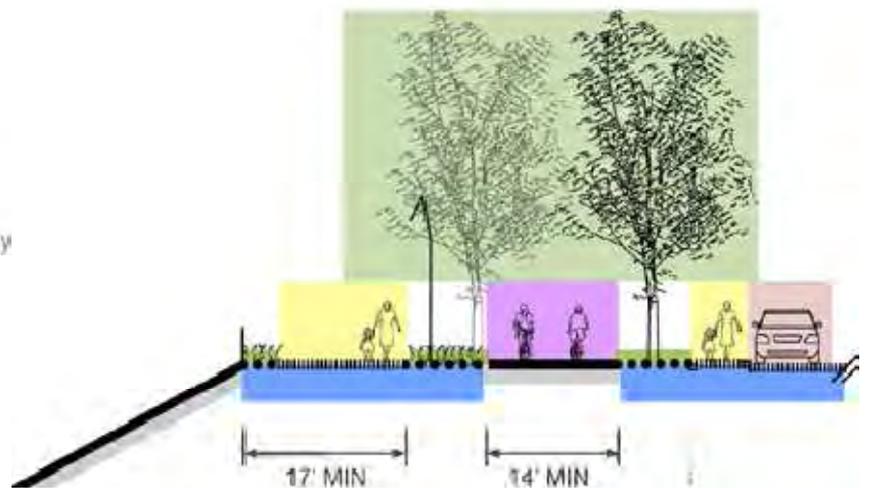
Straße mit Geh.- und Fahrradweg
